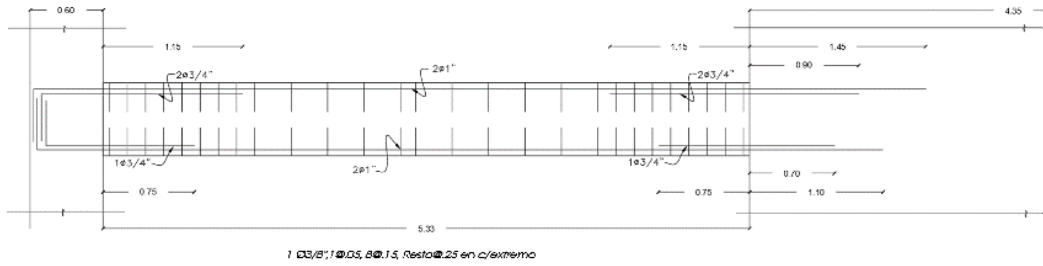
Detalle del refuerzo para la viga VT-07, tramo 1-3
